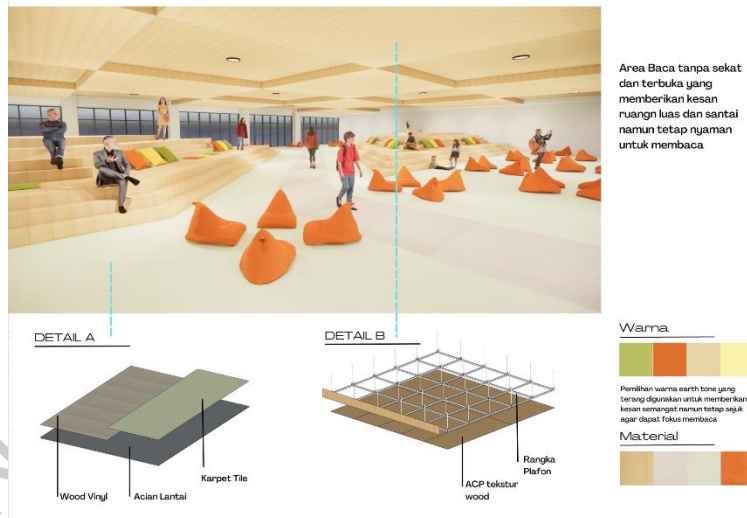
15 Bangunan Utama Lt.2 (Co-Working Space)
